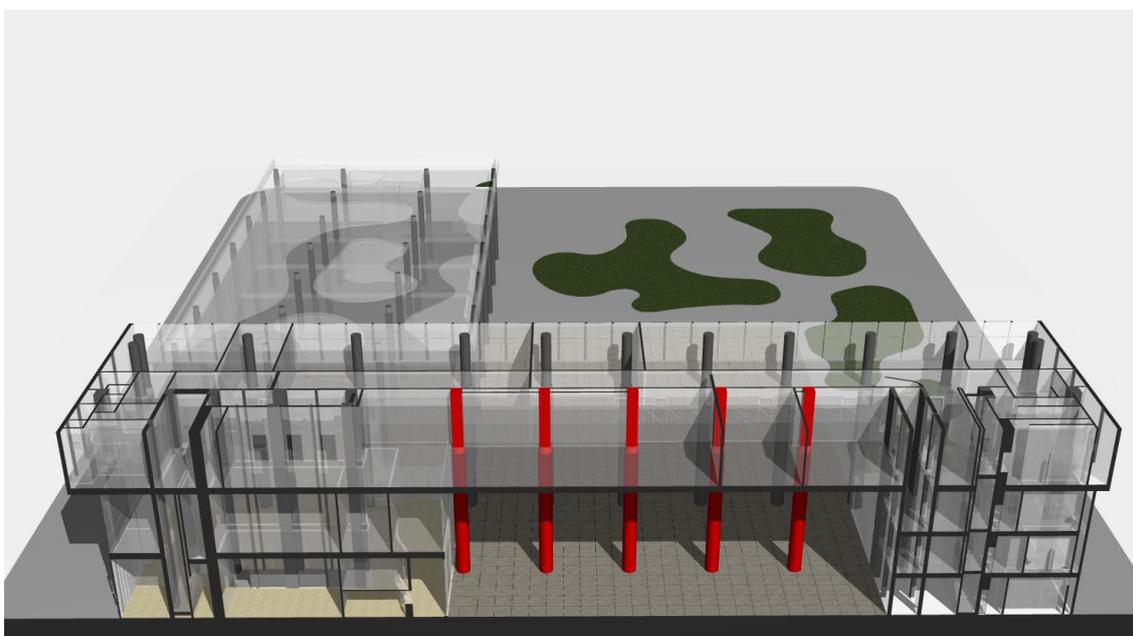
Malha de pilares no modelo em destaque (vermelho)
